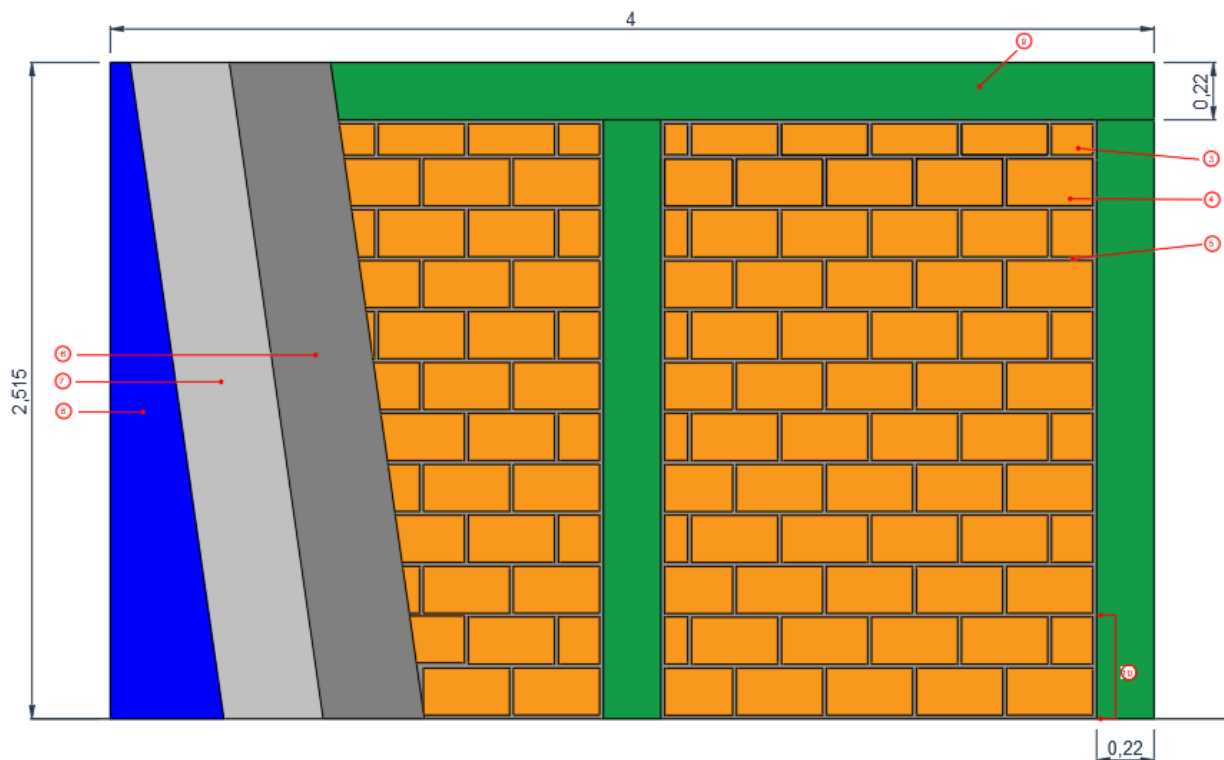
Vista del muro Tipo A, en ladrillo hueco tradicional y estructura de Hº Aº.
